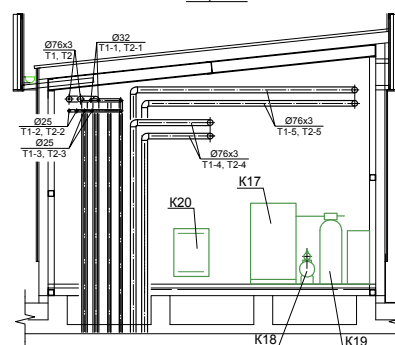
Распределение нагрузок по контурам: отопление, вентиляция, горячие водоснабжение
